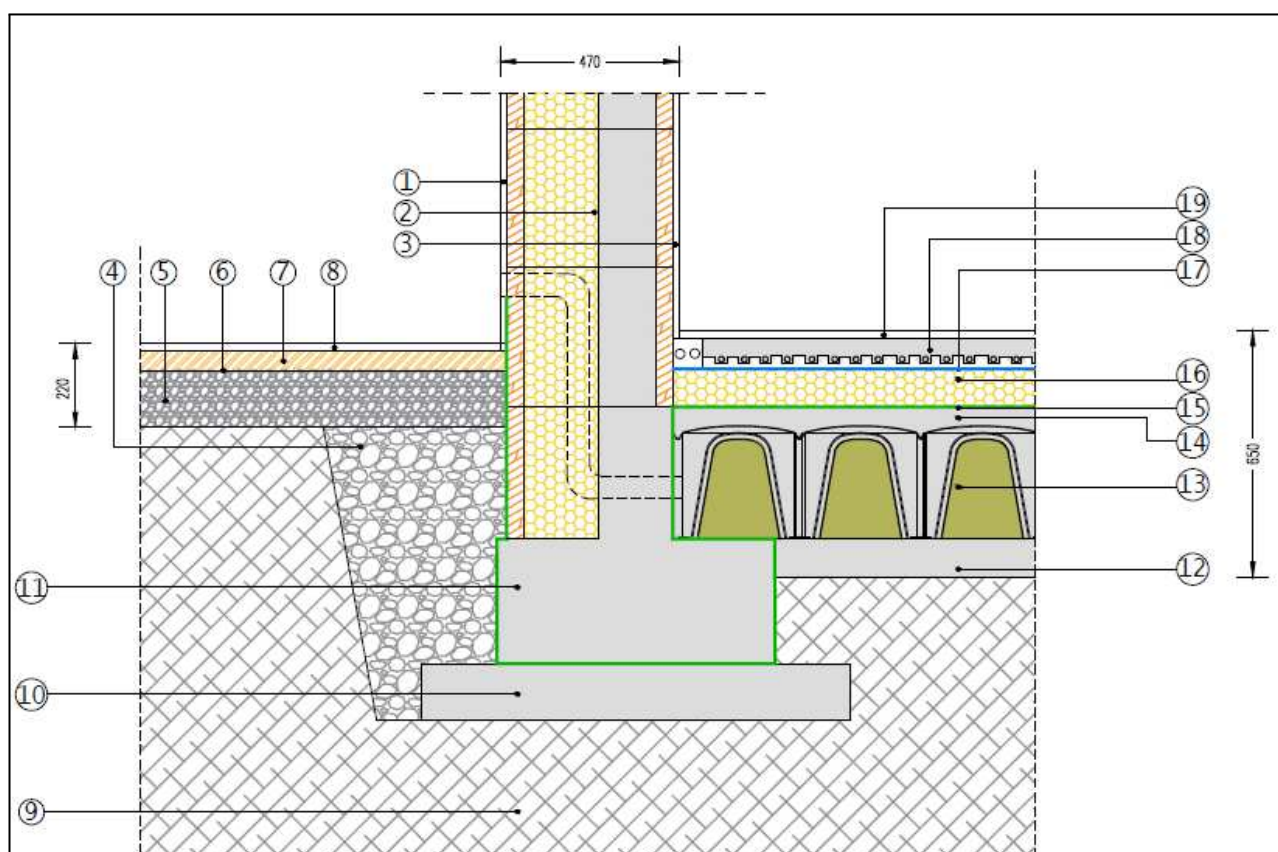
Sistema con blocco cassero in legno cemento, nodo fondazione-parete perimetrale-solaio controterra-pavimentazione esterna
